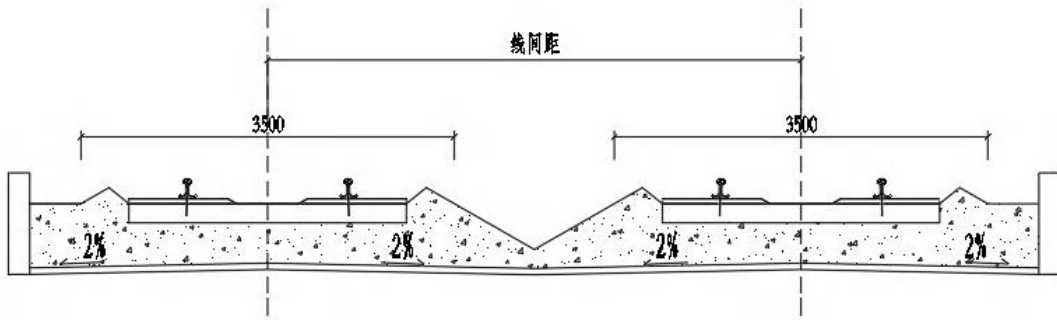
桥梁（隧道）段有砟轨道横断面图
